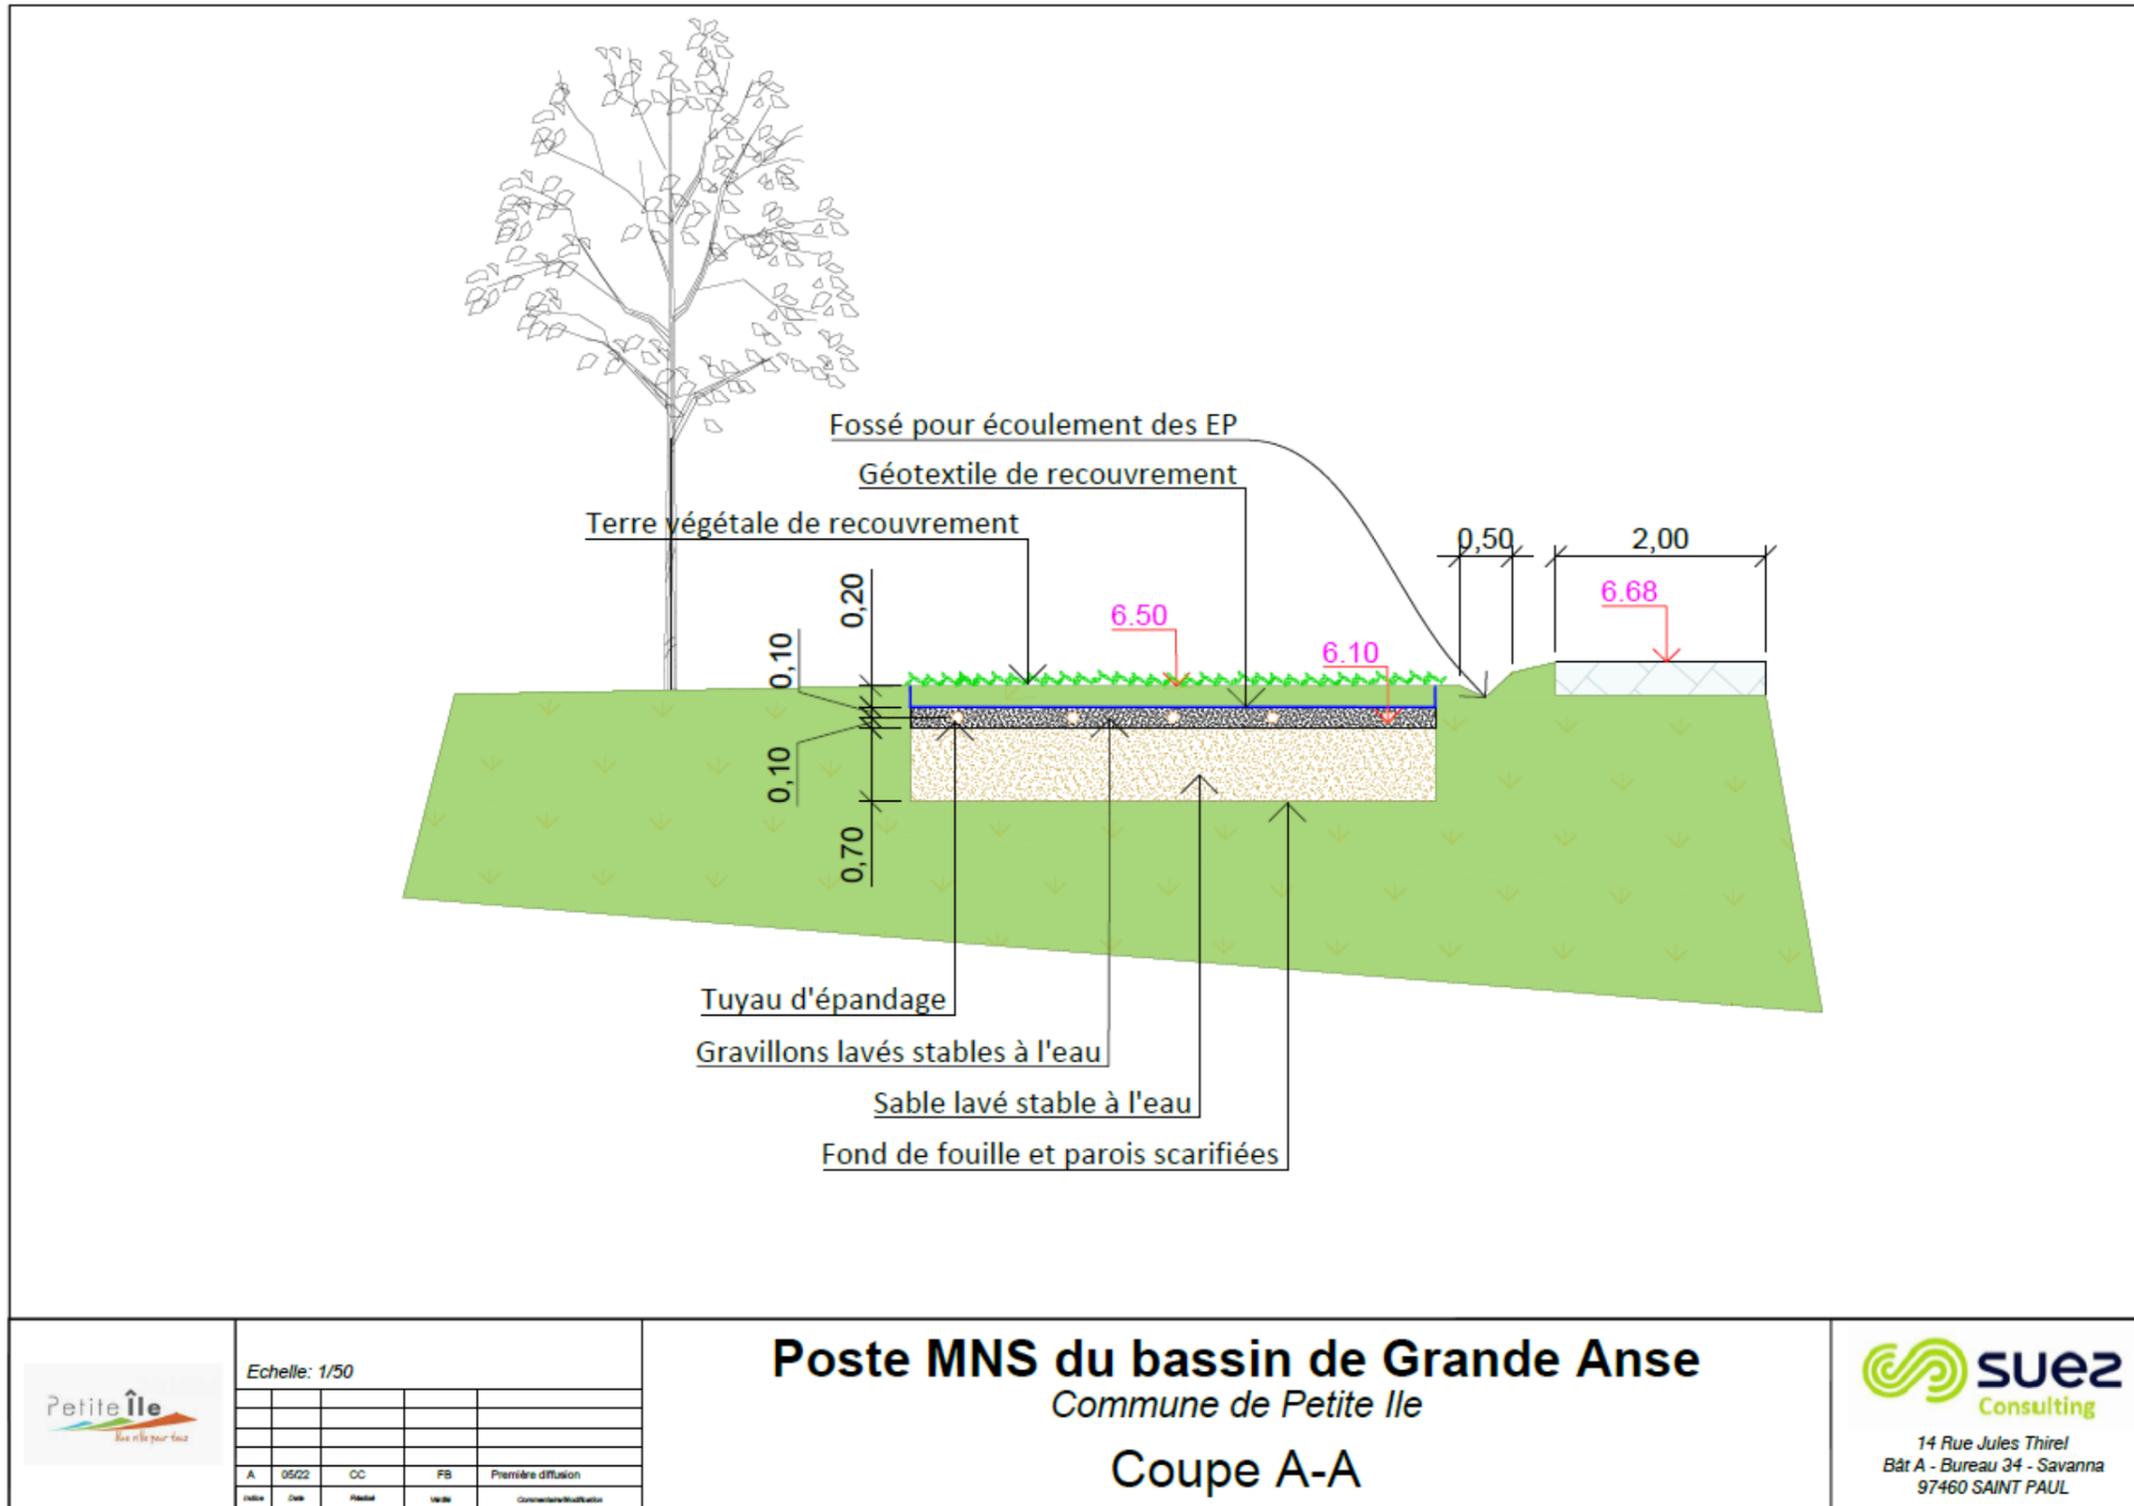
Plan de coupe A-A du système d'assainissement autonome envisagé
